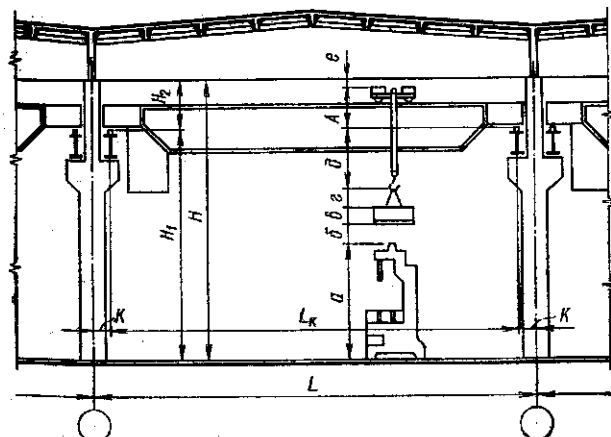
Схема разреза одноэтажного здания к определению параметров пролета
